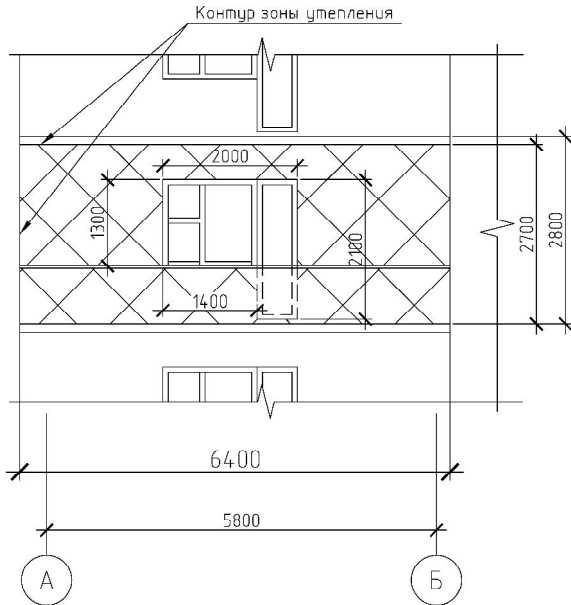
Фасад квартиры в осях «А-Б» / The facade of an apartment in the axes «A-B»
